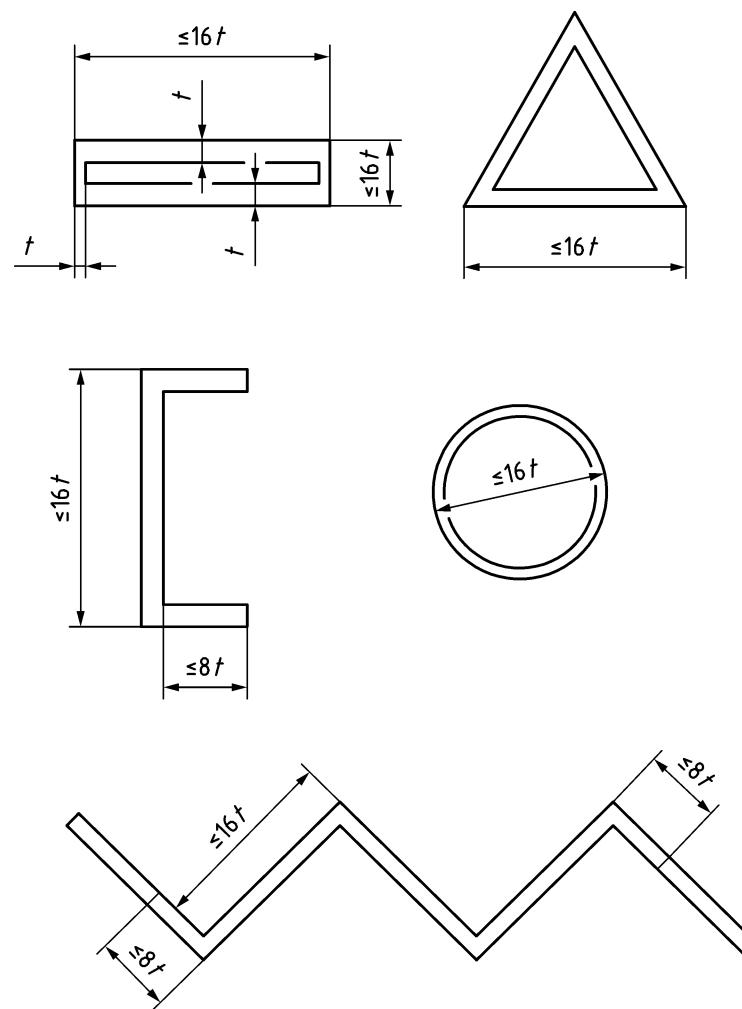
Beispiele für komplexe geformte Bauteile mit Längenbegrenzungen von Wandbestandteilen
